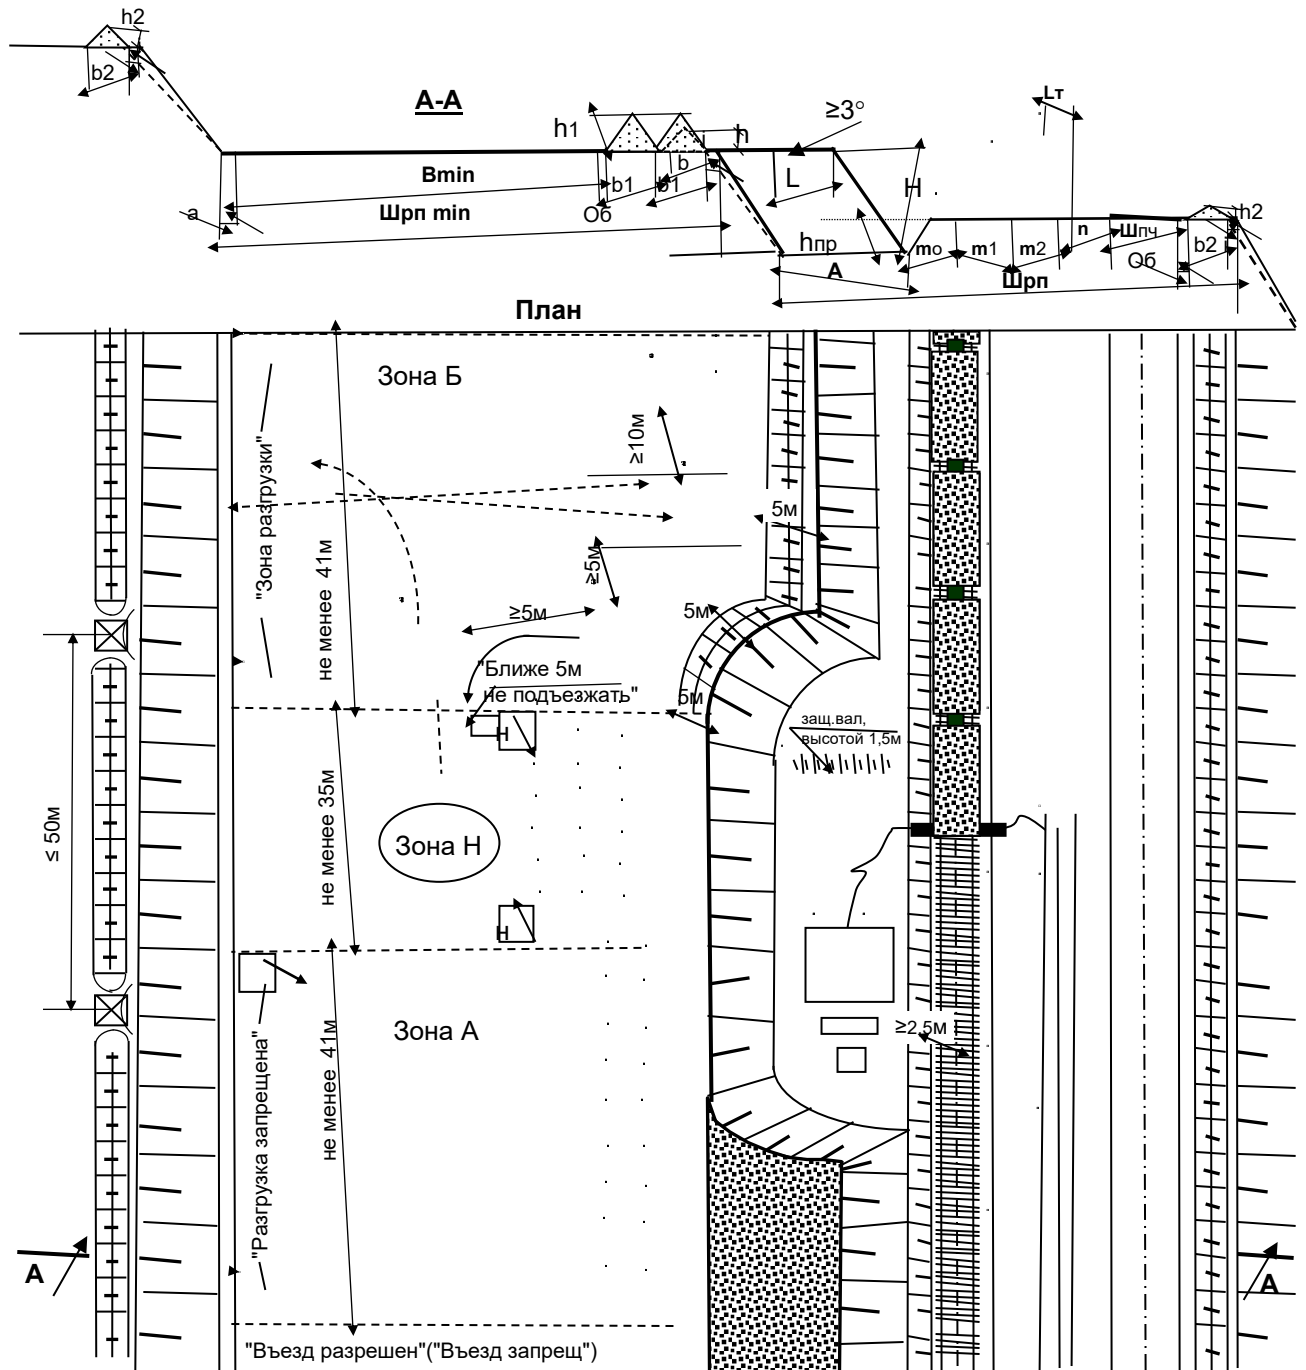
Работа экскаватора на перевантажувальном пункті
